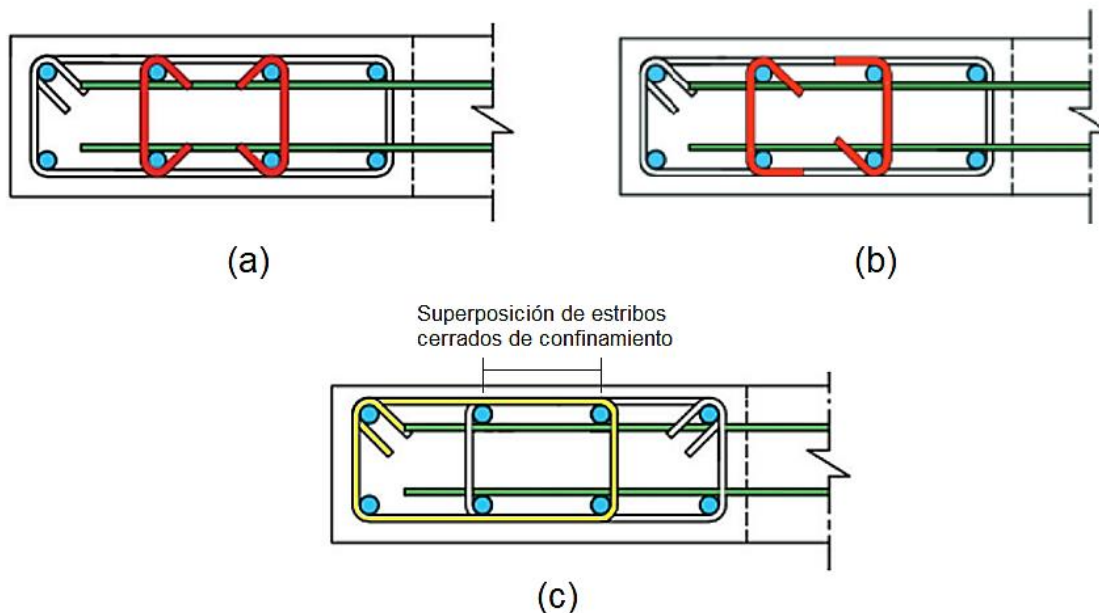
Ejemplos de tipologías de confinamiento del elemento de borde: a) Estribos cerrados de confinamiento superpuestos b) Estribo cerrado de confinamiento perimetral y ganchos suplementarios. Adaptado de Abdullah & Wallace (2019)
